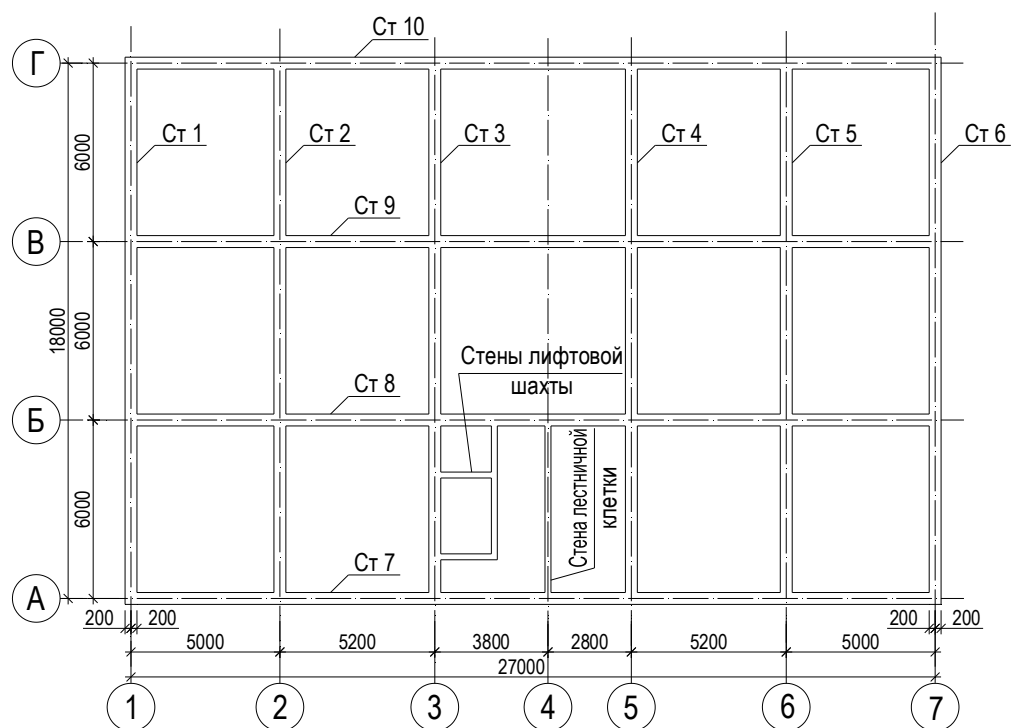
Схема расположения стен подвала и продольных и поперечных стен подвала.
